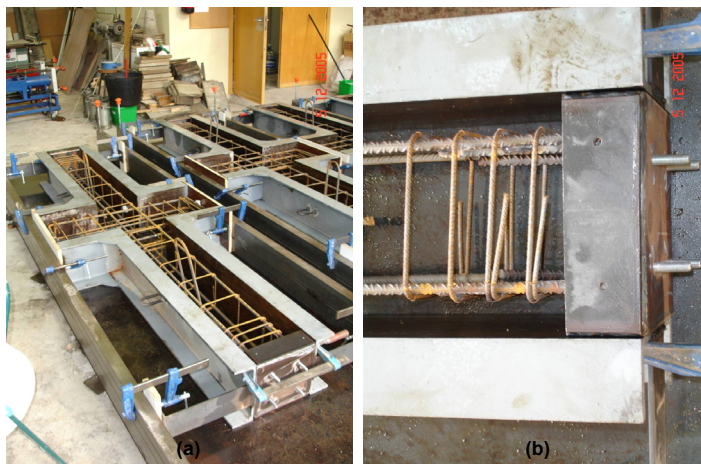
(a) Vista general del armado de las probetas; (b) Detalle de uno de los extremos de las probetas
